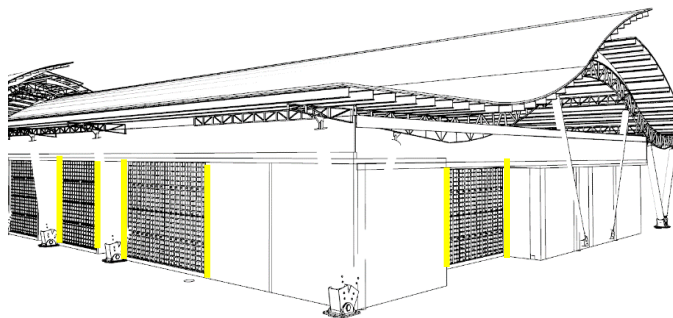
Ladrillo perforado en fachadas principales Fuente: propia
